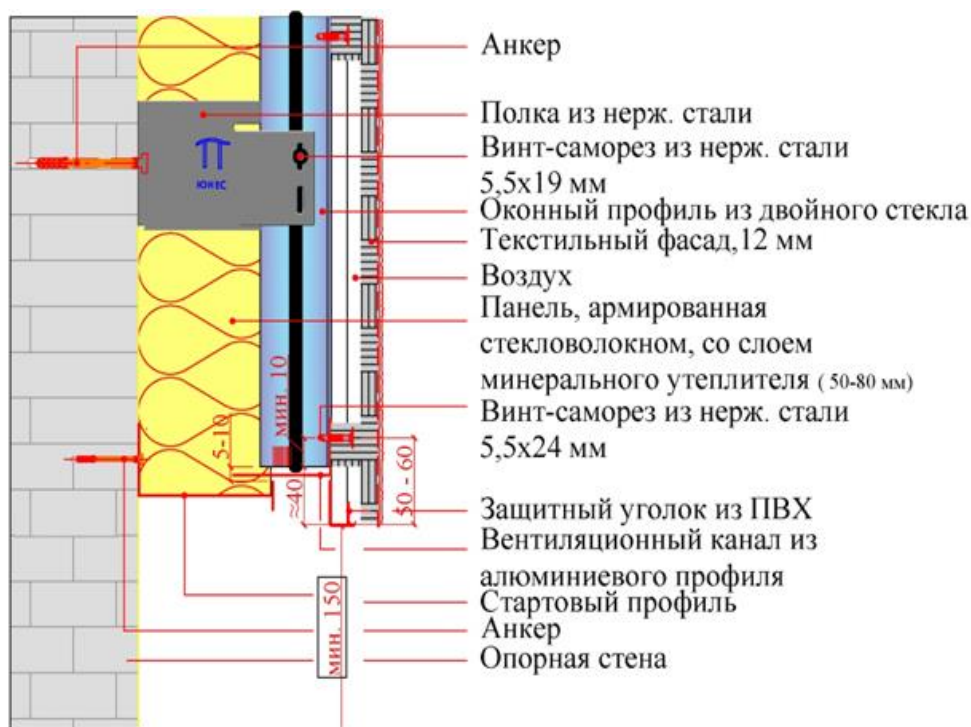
Схема разрабатываемой текстильной фасадной конструкции вентилируемого фасада
